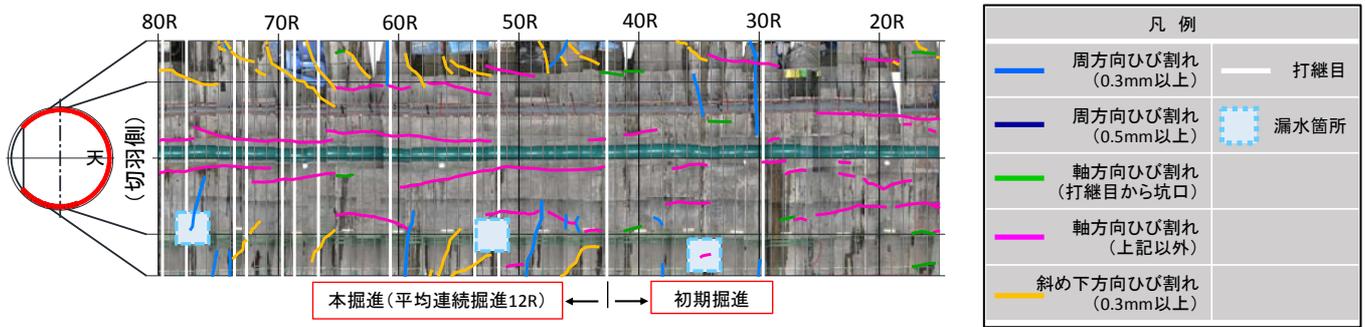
区間Aにおけるひび割れ展開図(小土被り直線施工区間 16R~80R)
